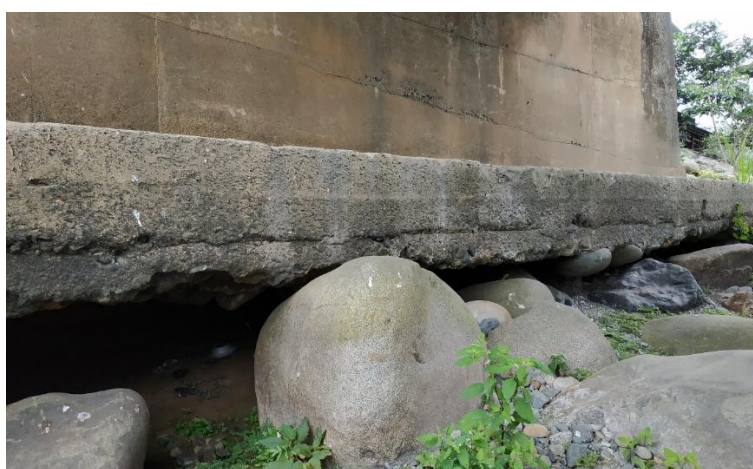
Fuerte erosión en el estribo izquierdo del puente.
